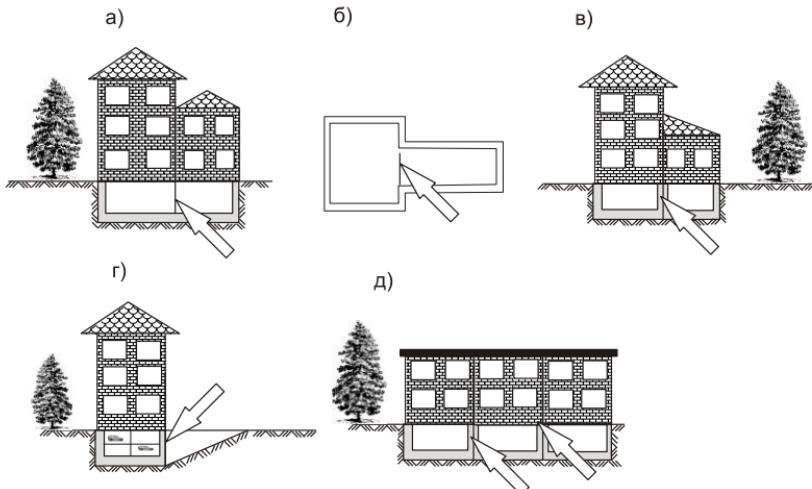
Типы зданий, в которых на практике устраивают деформационные швы: а) разноэтажные, б) со сложной формой фундамента, в) с пристройками на отдельных фундаментах, г) с подземными гаражами, д) большой протяженности
